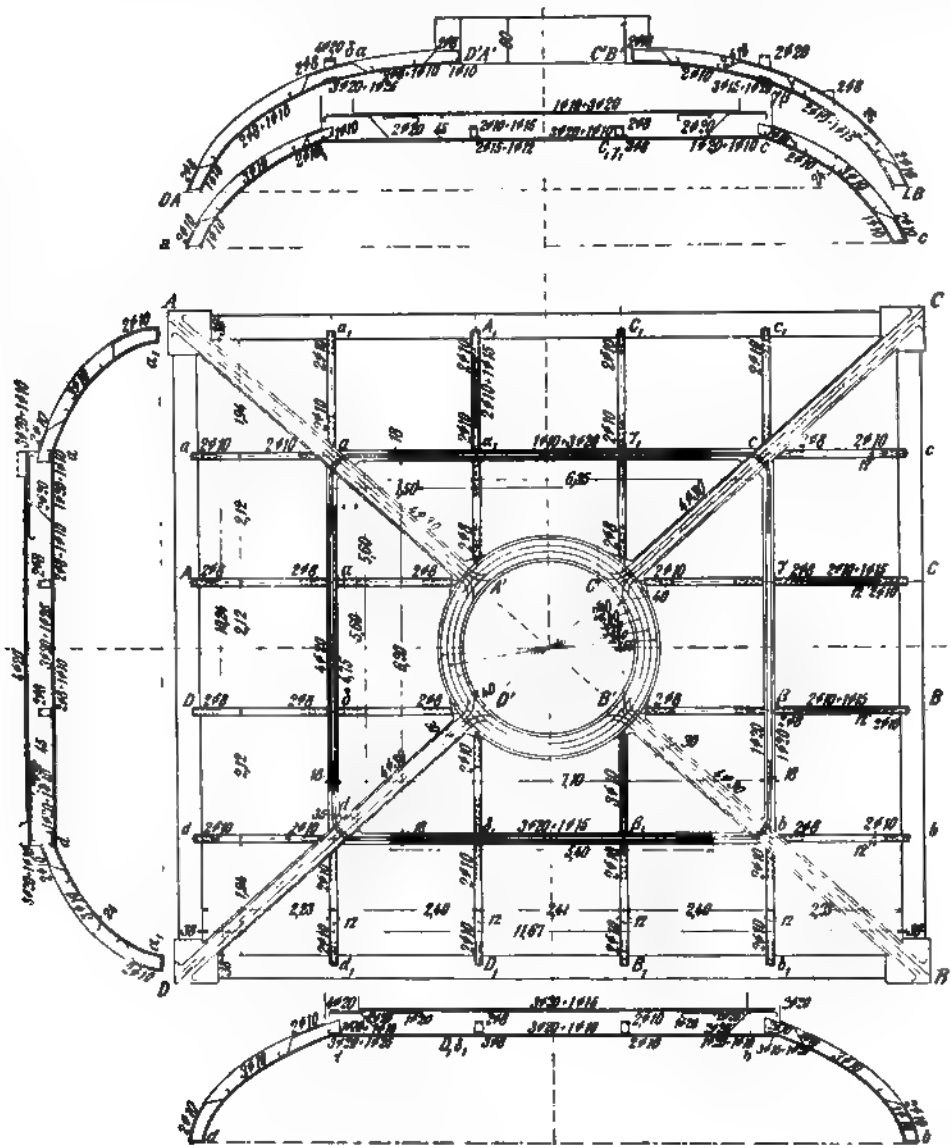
Dampfkochküche Frankfurt a. M. Grundriß und Schnitte der Rippenkuppel.
